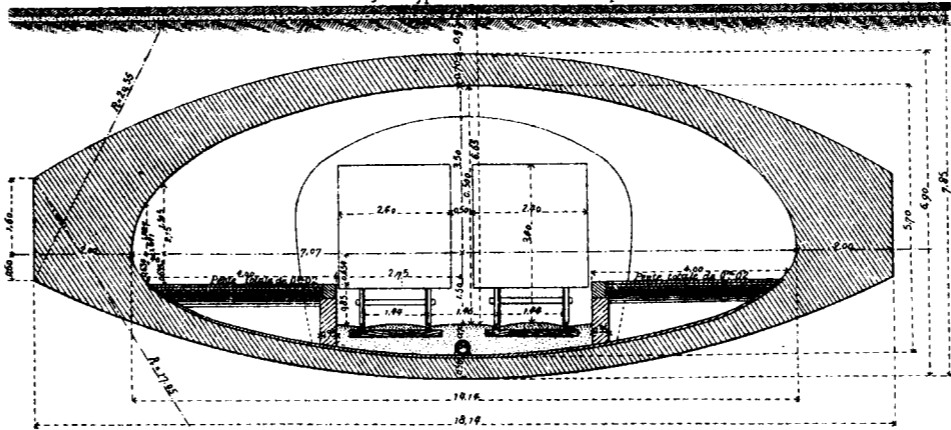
Coupe longitudinale d'une station avec plancher métallique.
